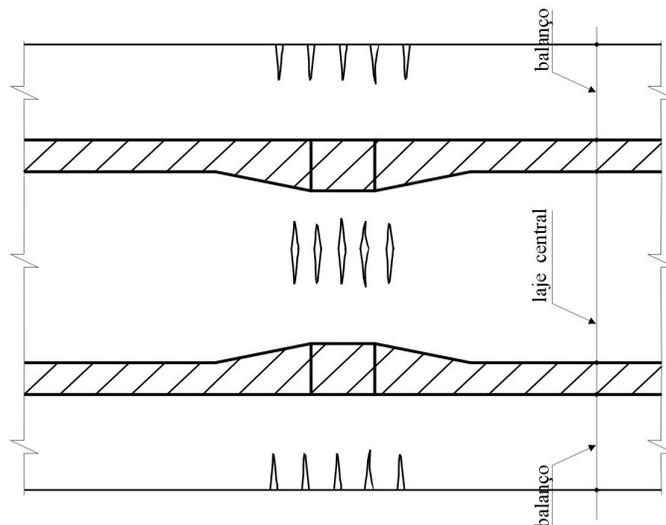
Fissuras nas lajes juntos aos apoios
